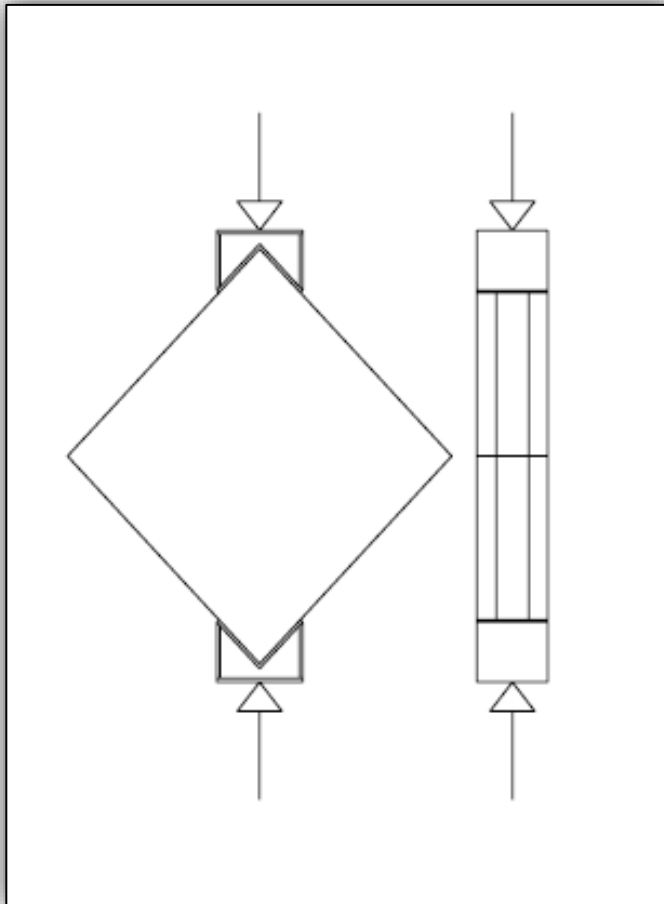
muro di dimensioni ridotte, layout prove di compressione diagonale
